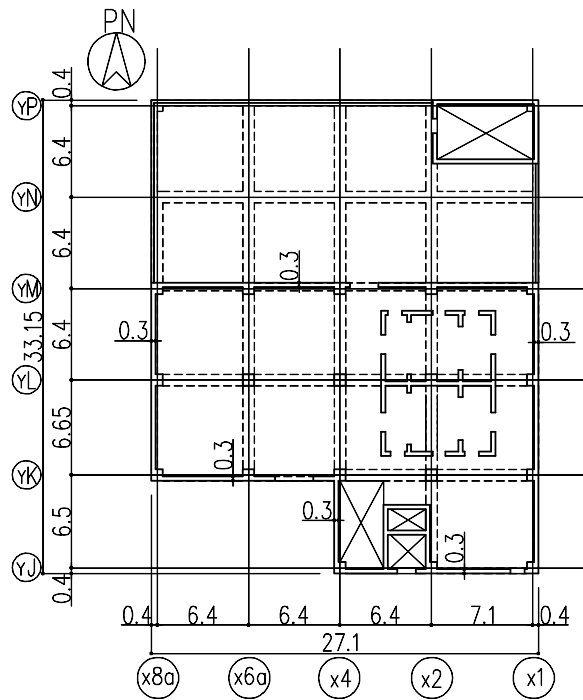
塔屋階平面図 (G.L.+11.0) (单位:m)
